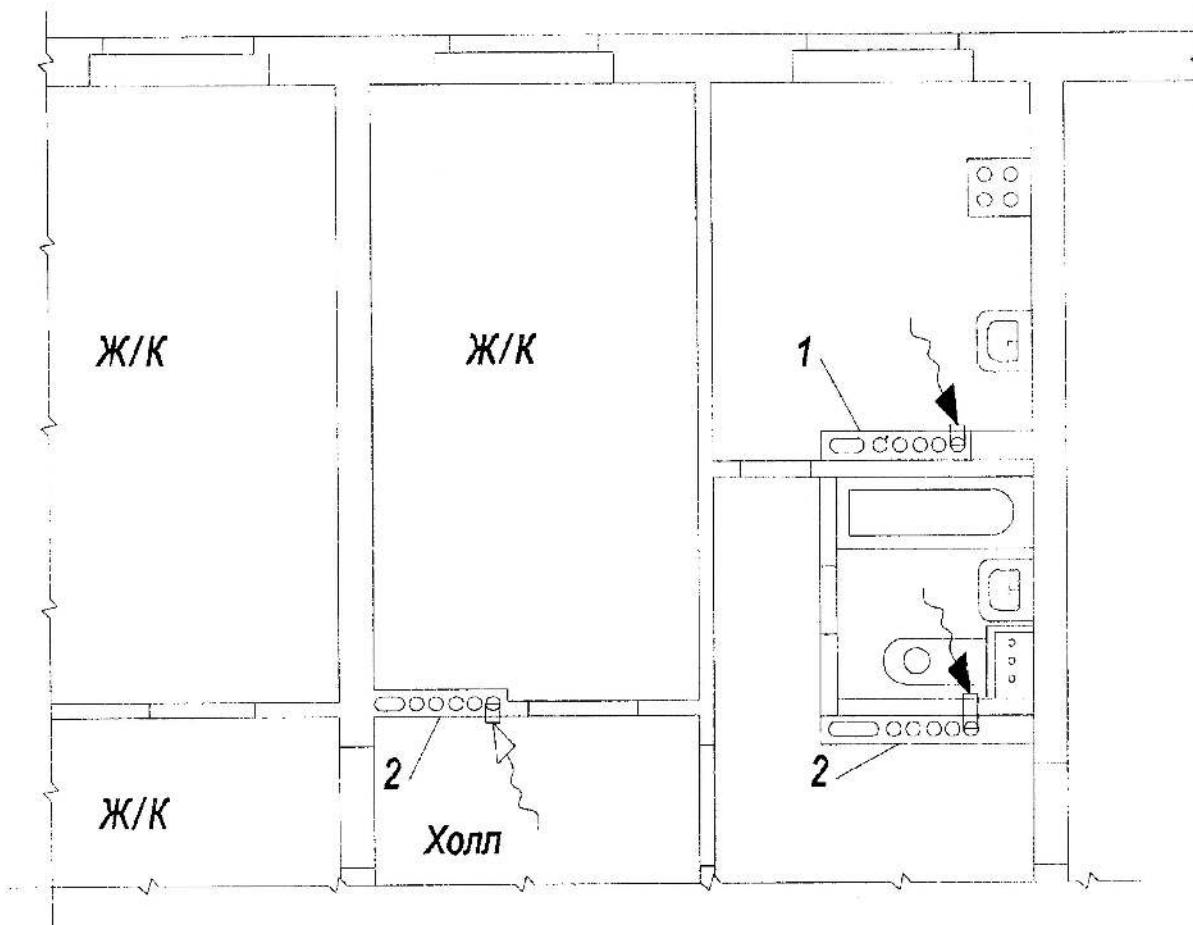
Пример решения системы вентиляции квартиры большой площади шестнадцатиэтажного жилого дома с применением вентиляционных панелей-перегородок с наклонными каналами (1 – вентиляционная панель-перегородка для кухни; 2 – вентиляционная панель-перегородка для санузла; 3 – дополнительная вентиляционная панель-перегородка с удалением воздуха из холла прихожей из-за недостаточности сечения вентиляционного канала кухни)
